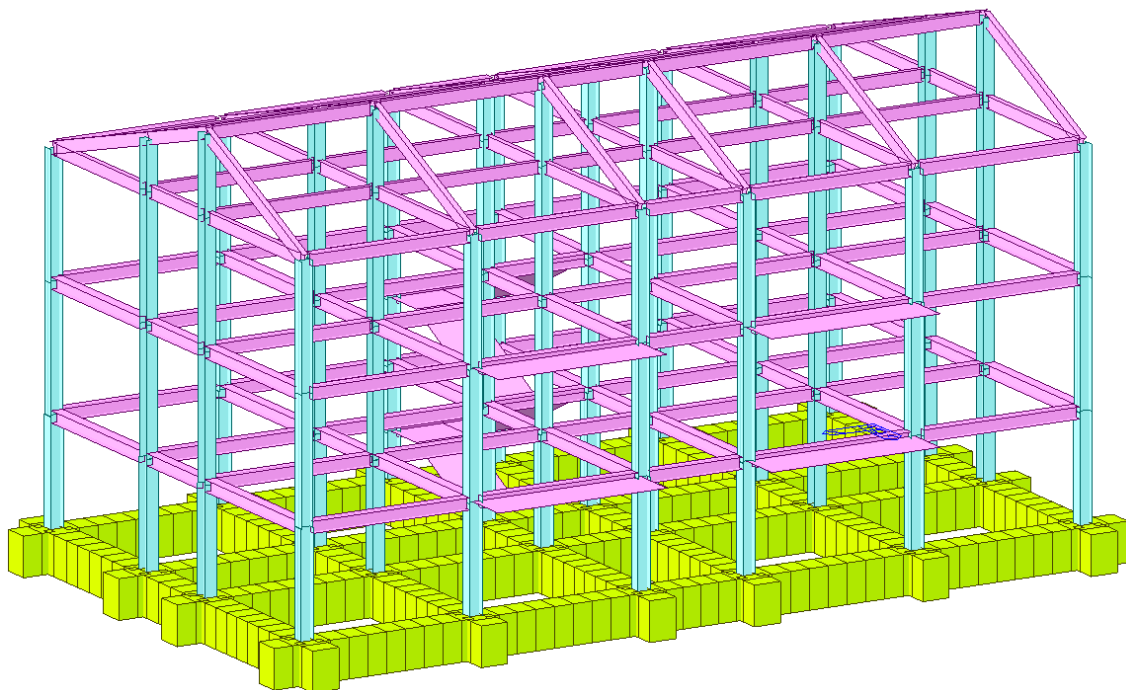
Modello FEM edificio a tre piani in acciaio con trave rovescia - Vista assonometrica 2.
